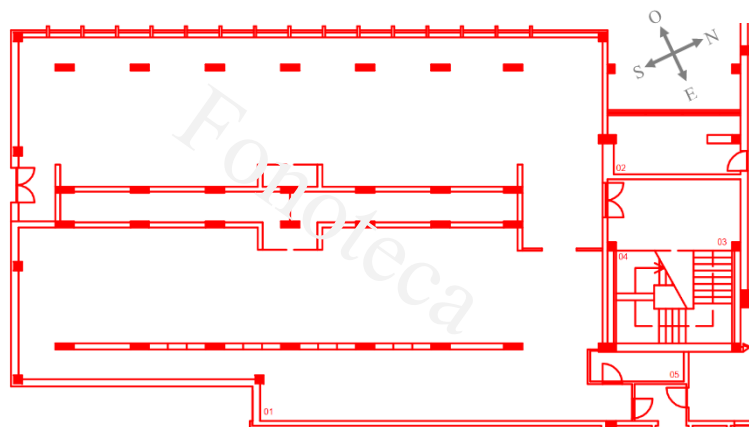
Instalações da Fonoteca, situadas no piso -3.
